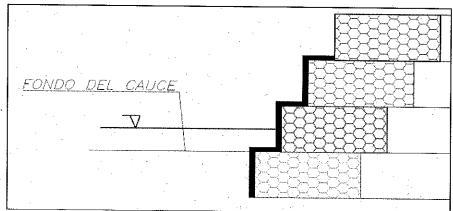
Perfii de niveles de muro gavión respecto a fondo del cauce Fuente: CENIT, 2018.
